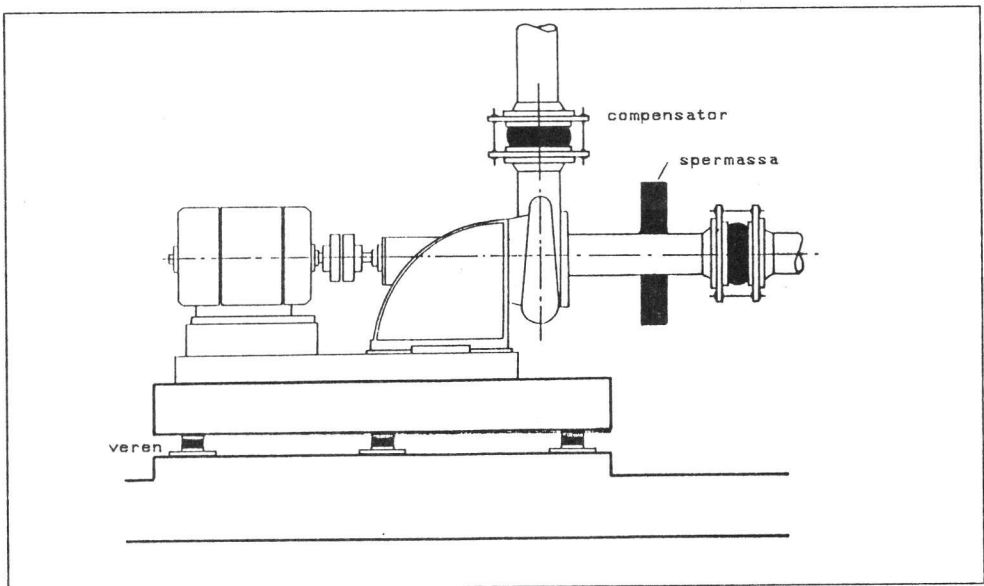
Voorbeelden van bevestiging van pijpleidingen waarmee de voortplanting van trillingen in de wandconstructies wordt voorkomen.
